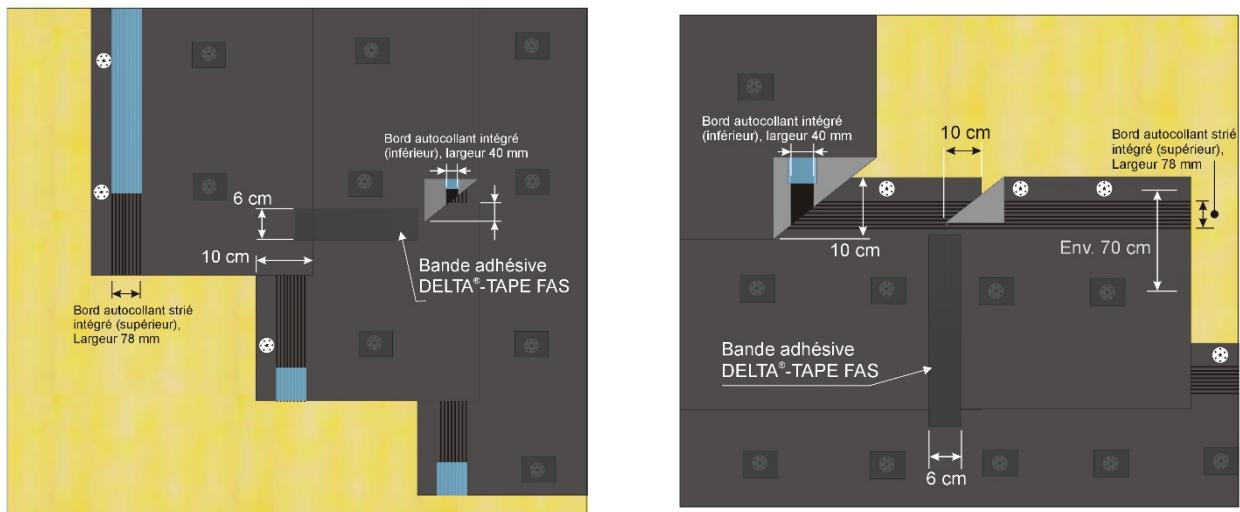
Membrane de protection Delta Fassade 20 Plus en pose verticale et horizontale
